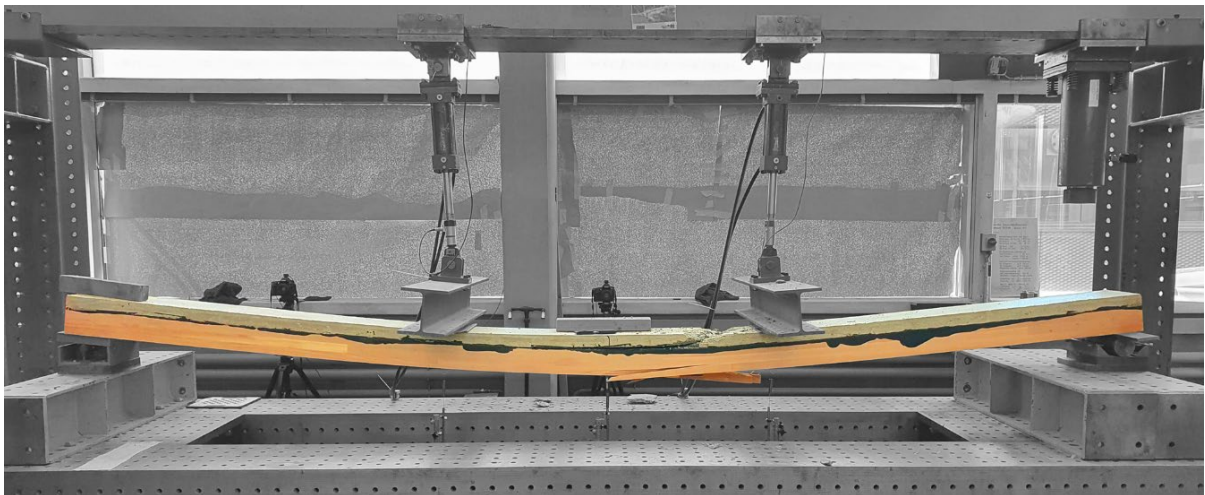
Vier-Punkt Biegeversuch mit verklebten Holz-Beton-Verbunddeckenelementen
